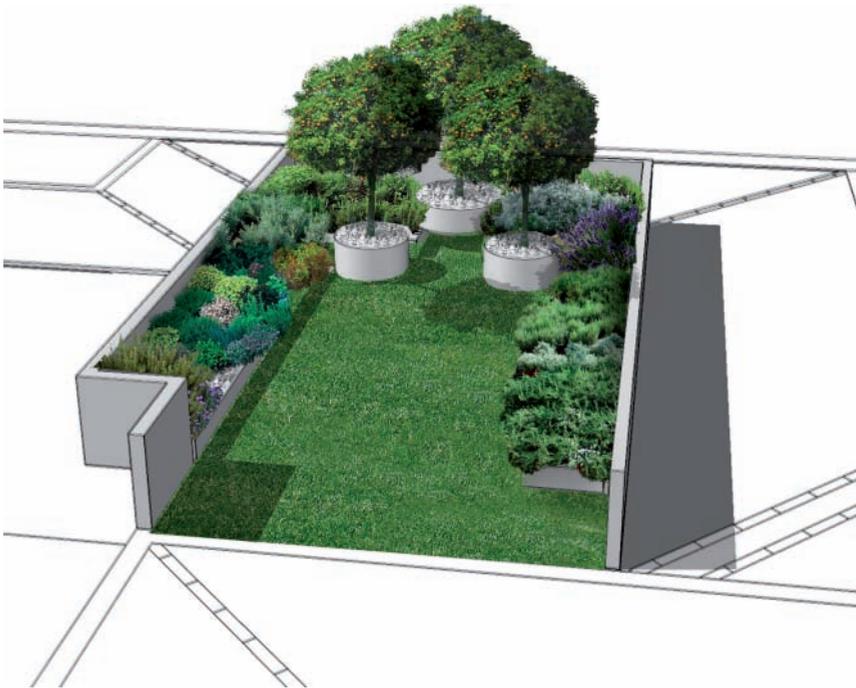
Prospettiva terrazzina inferiore, seconda soluzione (fonte: archivio Laboratorio di Architettura Ambientale di Catania)
